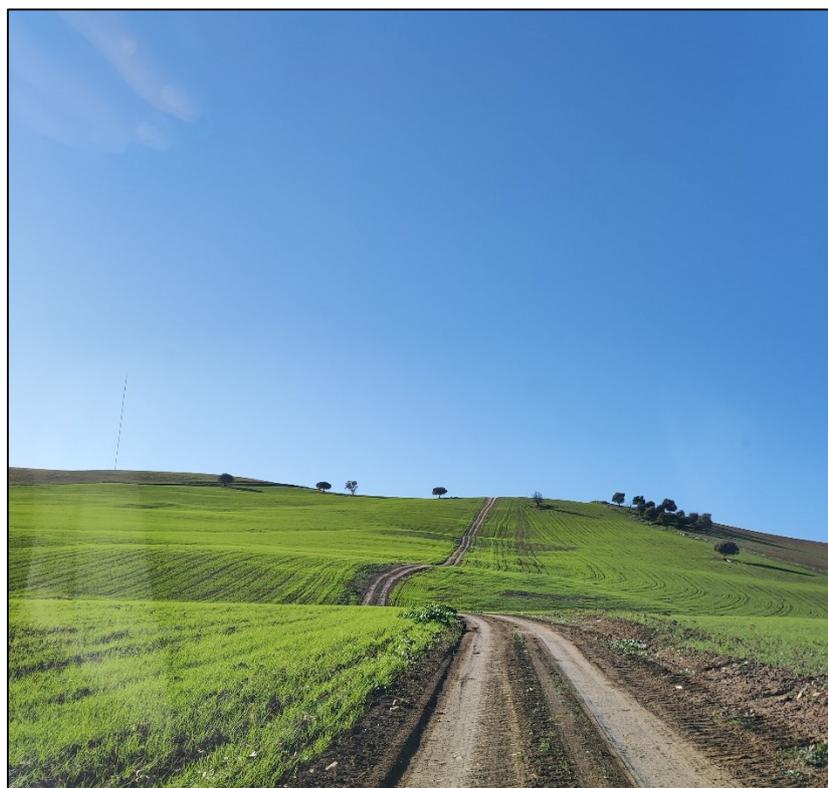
strada temporanea di cantiere lungo il Blocco A
